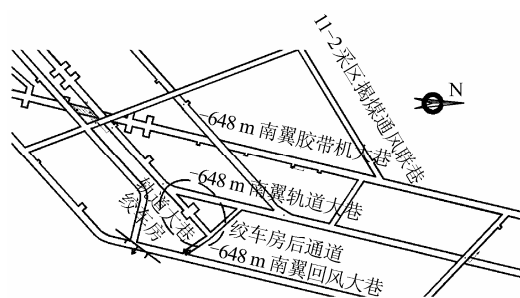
南翼轨道大巷 2.5 m 绞车房平面布置图
